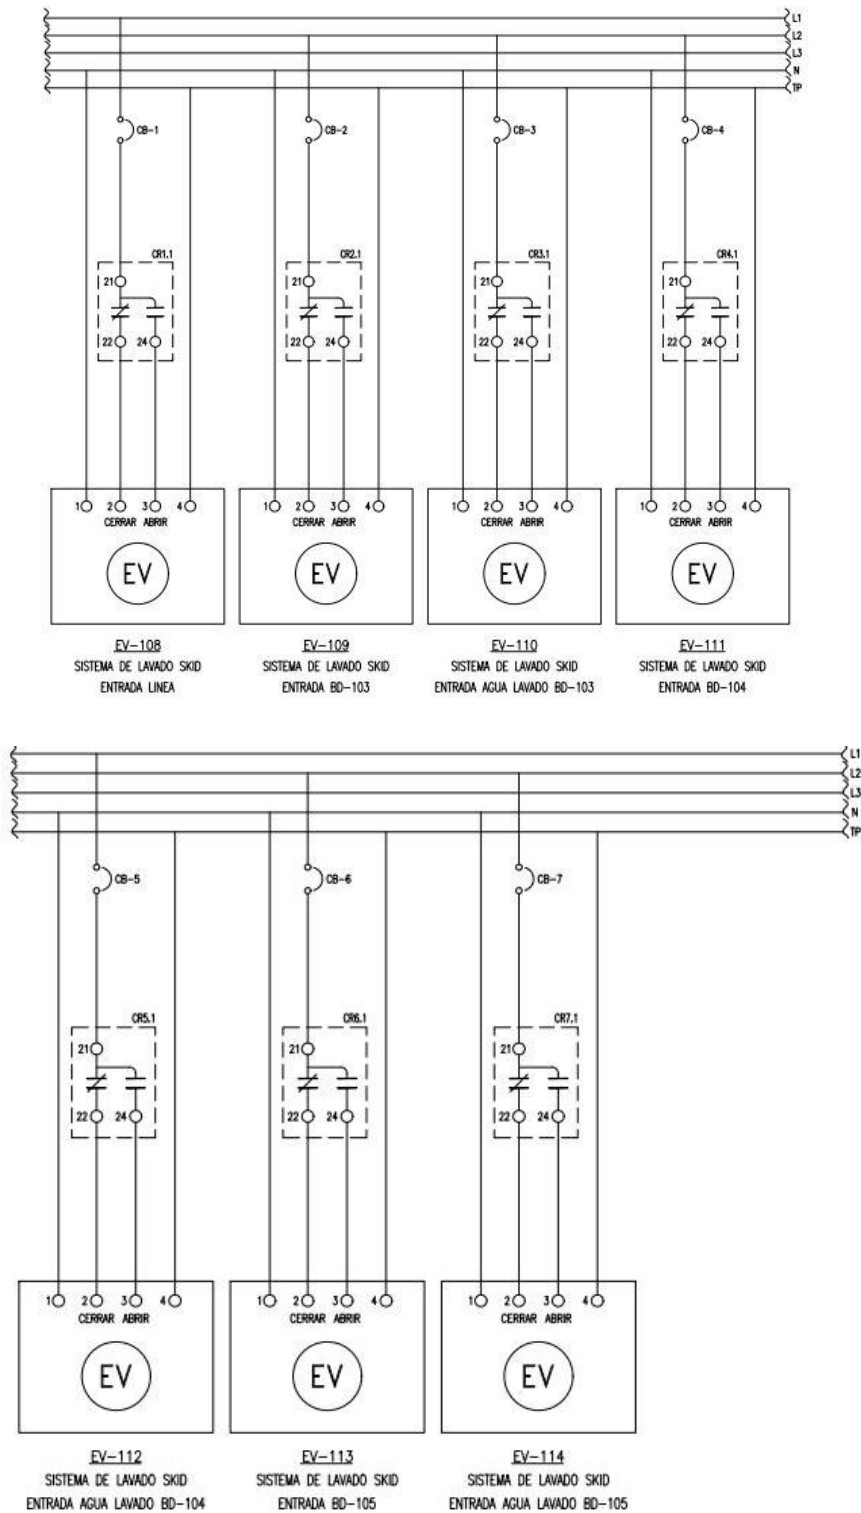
Plano Bifilar Válvulas Lavado, TDFyC-103. Extracto de plano TC-5\_Talagante\_TDFyC-103\_Lavado [6]
